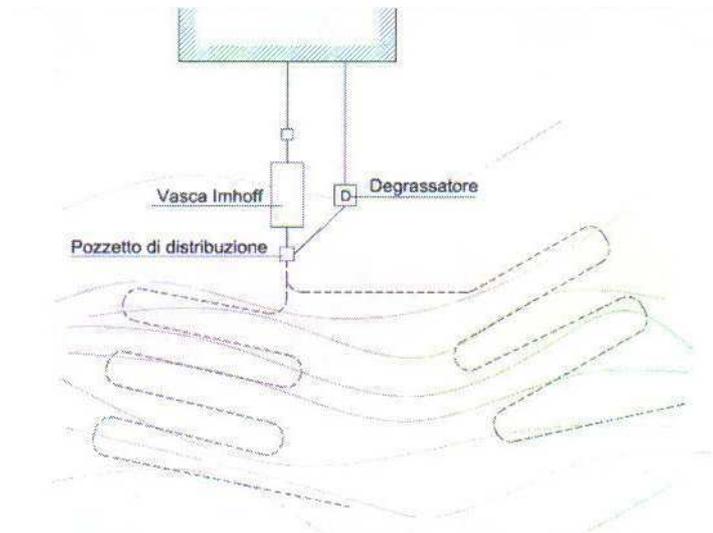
Andamento planimetrico delle condotte di sub irrigazione
